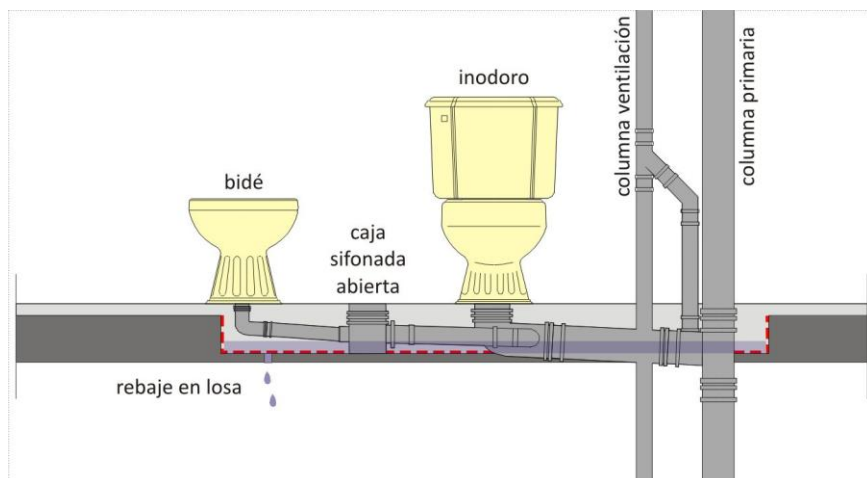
Impermeabilización en entrepiso con rebaje de cara superior de losa.
